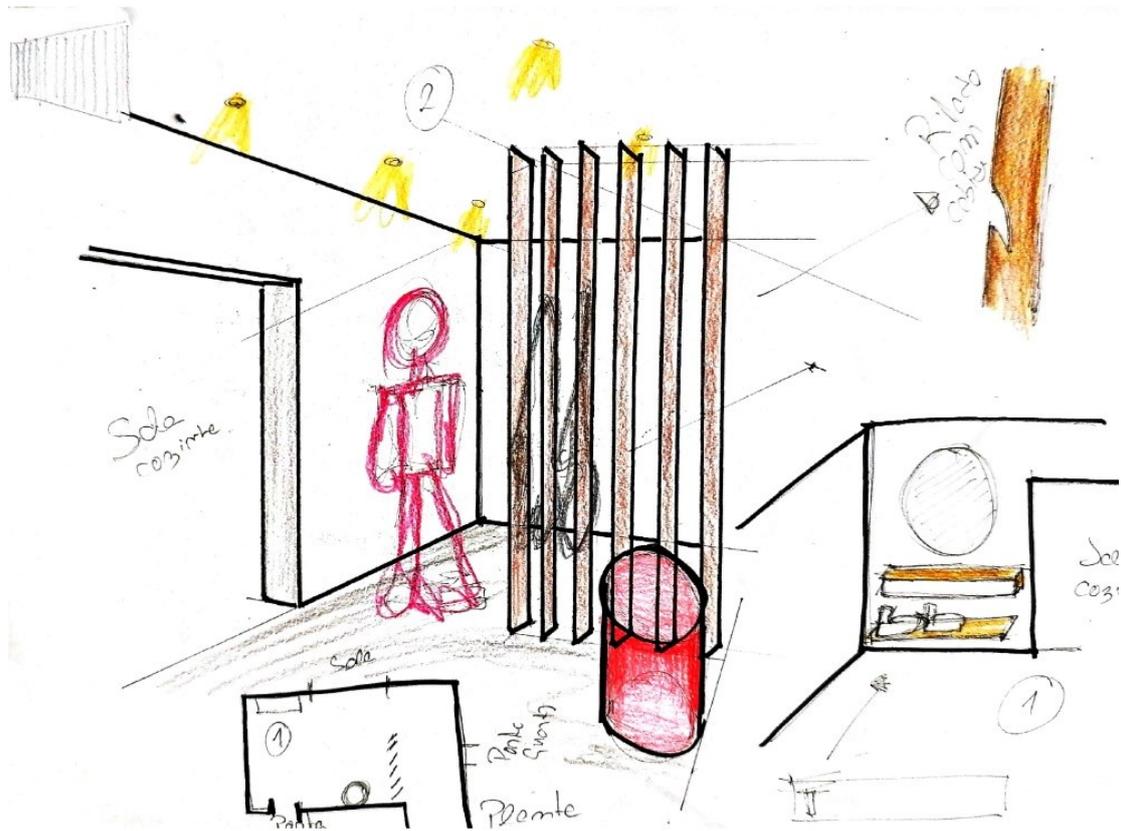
Hall de entrada, planta e vistas, desenho à mão levantada, André Bastos, 27\01\2023
